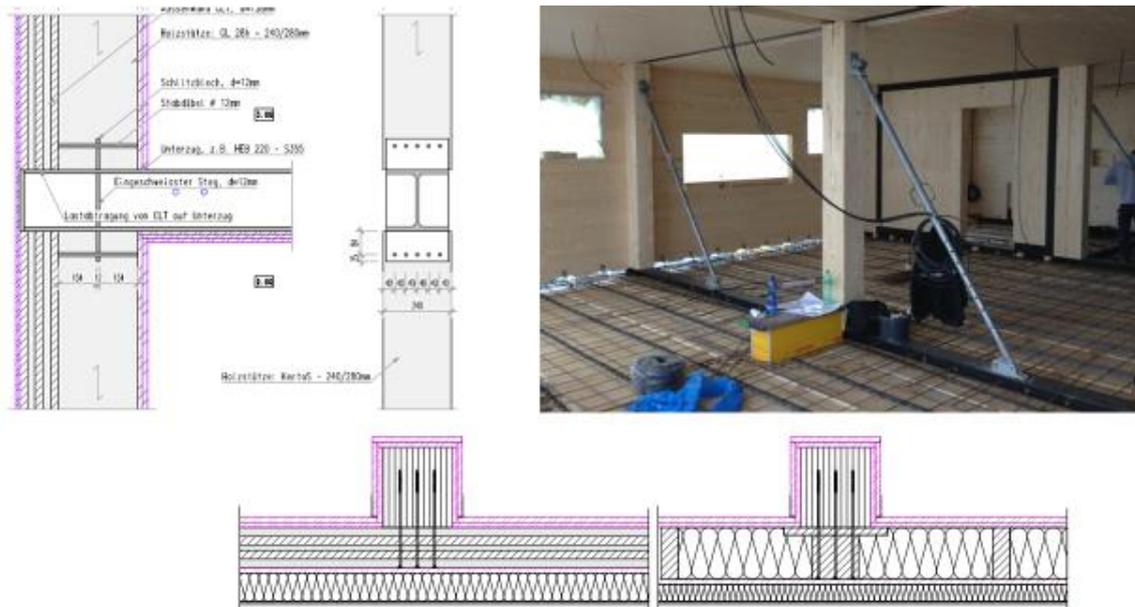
Konstruktionsprinzip beim C13 mit der tragenden Skelettkonstruktion und den nichttragenden Aussenwänden. Rechts eine Bild im Montagezustand.
